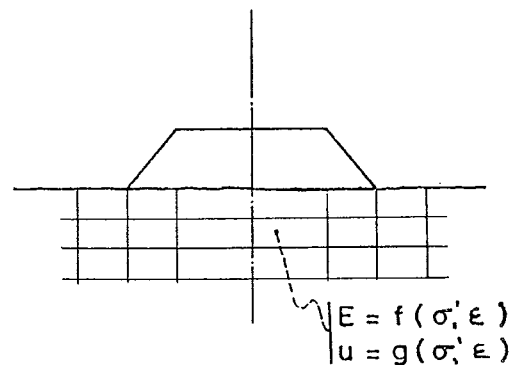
Metodi per valutare la stabilità del rilevato e della sua fondazione.
